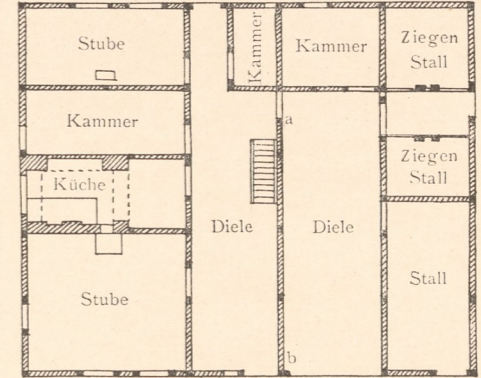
Ochsendorf. Grundriss. (Wand ab später eingebaut)
